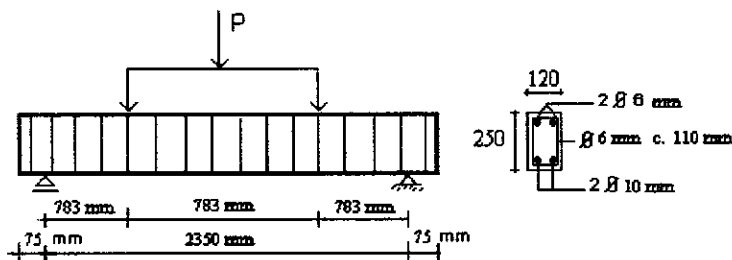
16 – Características das vigas ensaiadas por BEBER et al.
